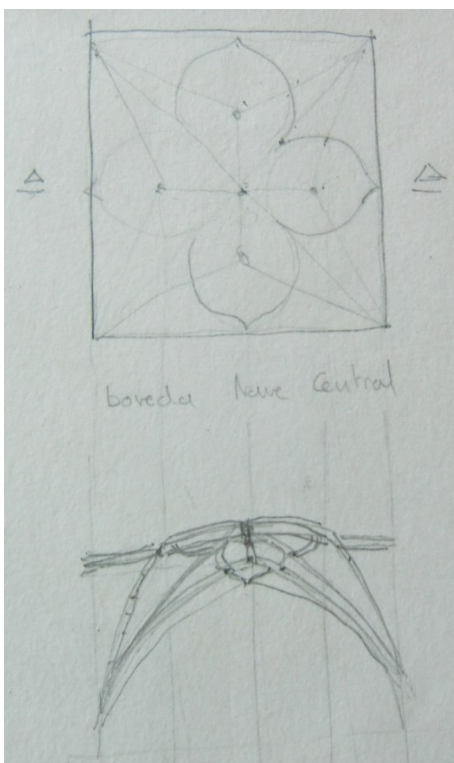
Análisis arquitectónico y constructivo - Croquis del levantamiento realizado por el autor
